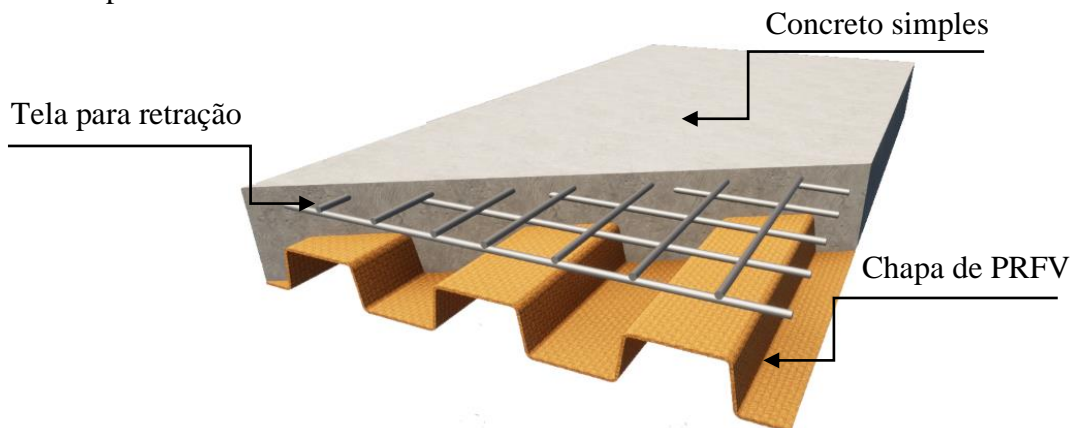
Geometria da laje mista com fôrma permanente estudada
